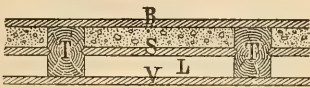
Konstruktion einer hölzernen Zwischendecke nach Stix.
